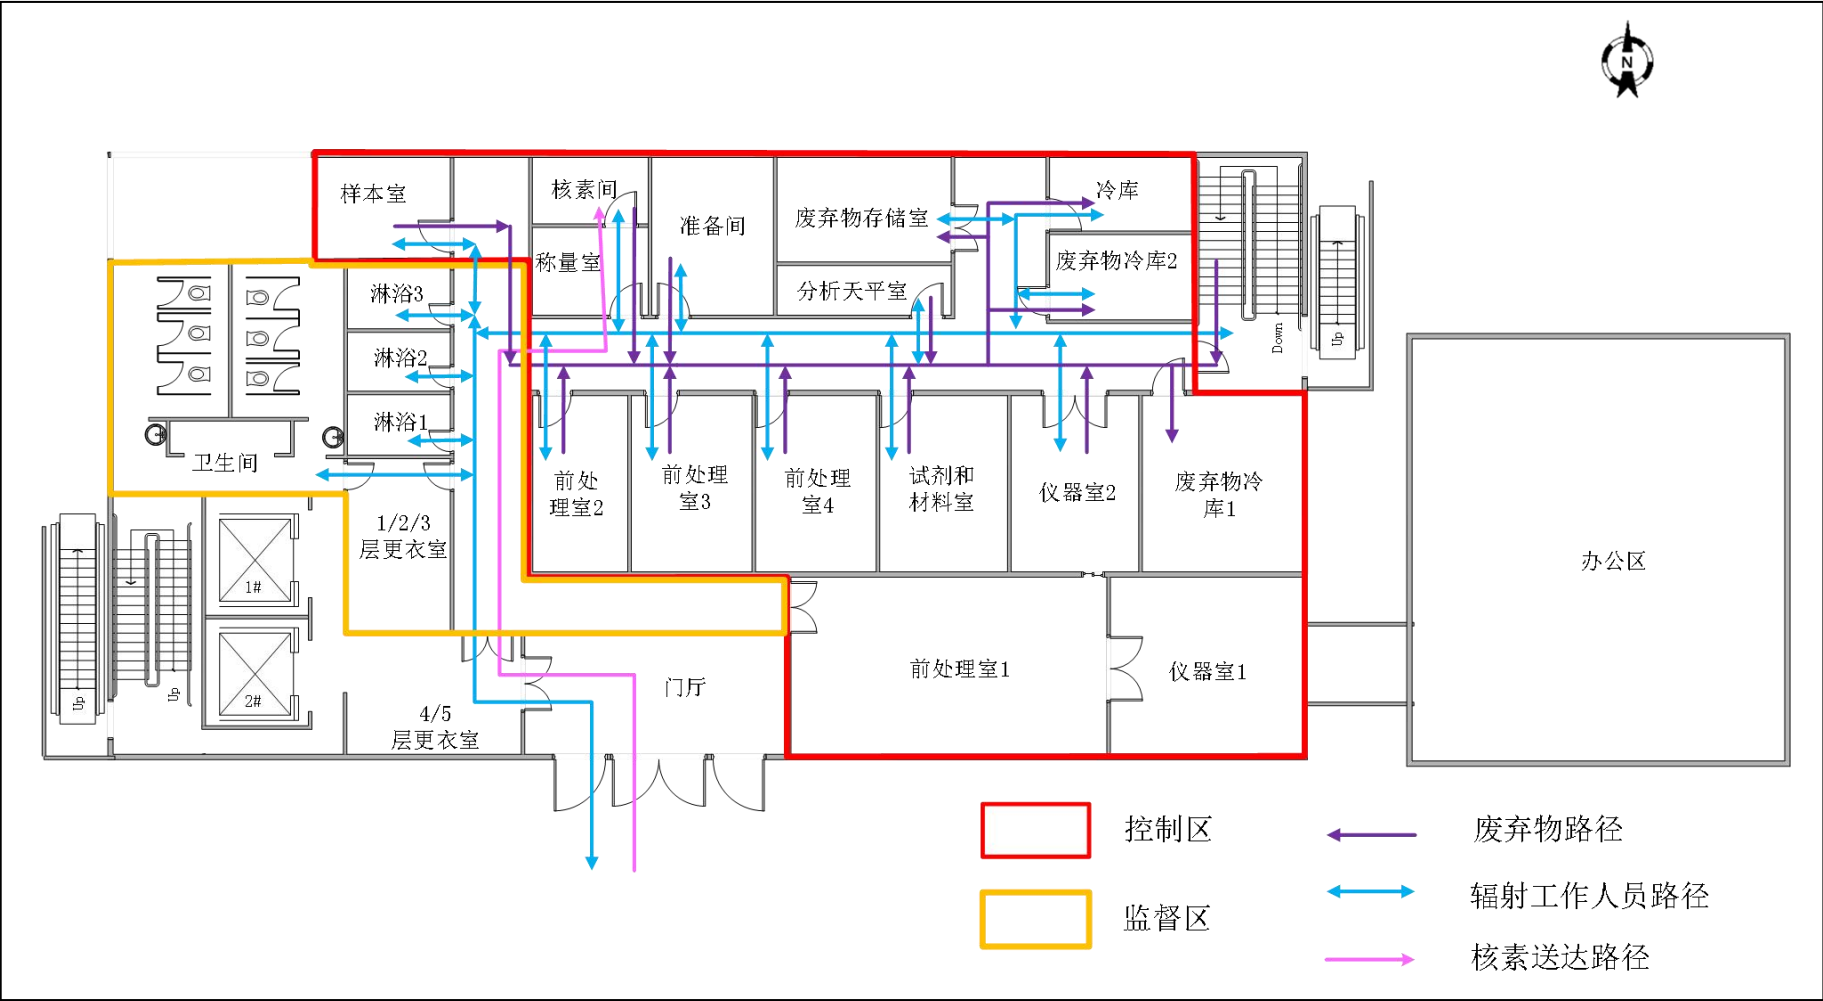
放射性同位素实验室一楼平面布置、两区划分及人员、物流路径示意图
